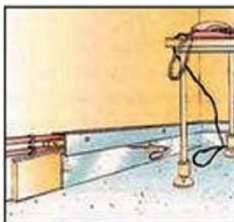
Оригинальное решение: трубы укрыты алюминиевым уголком, который нависает над зеркальной планкой.
